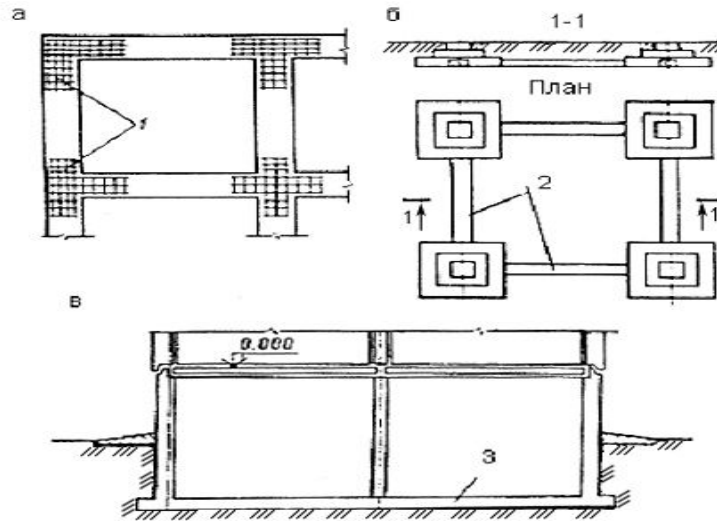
Конструкції фундаментів у разі сейсмічних впливів: *а* – план стрічкового фундаменту; *б* – план і розріз стовпчастих фундаментів; *в* – підвальна частина будівлі з плитним фундаментом; *1* – арматурні сітки; *2* – фундаментна балка; *3* – плита з монолітного залізобетону
